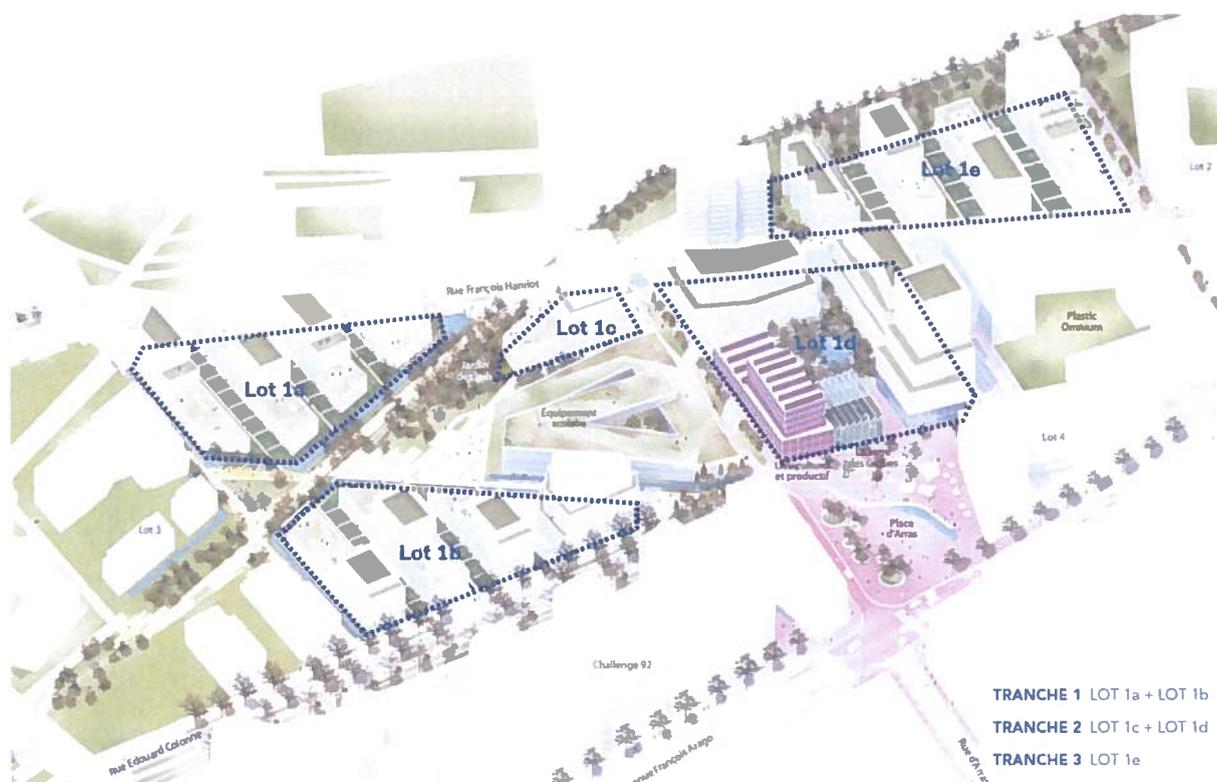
Plan masse du secteur 1 de la ZAC des Groues (Source : AUC Fiche de lot)
